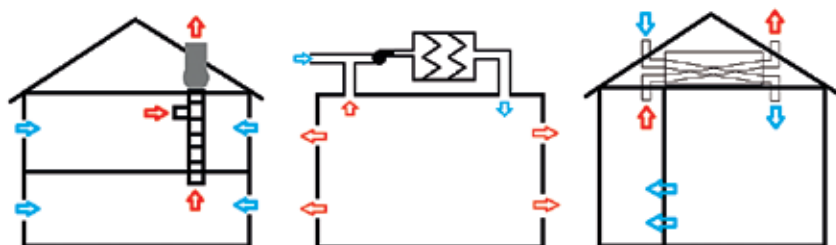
Способы вентиляции коттеджей [8]: а – система вытяжной вентиляции; б – система приточной вентиляции; в – система приточно-вытяжной вентиляции
